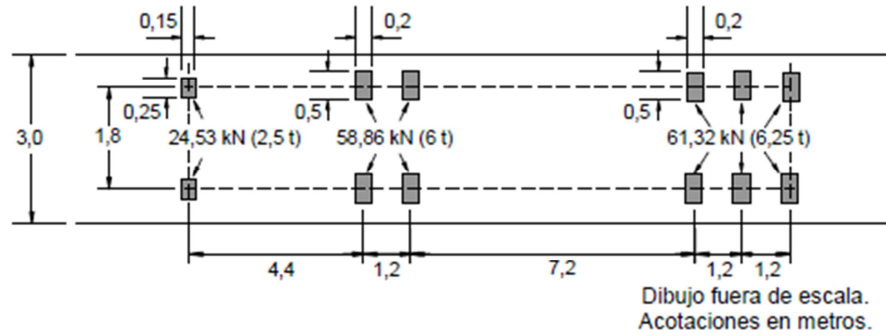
Modelo de cargas vivas vehiculares IMT 66.5, para el análisis transversal o tridimensional de puentes y estructuras similares.
